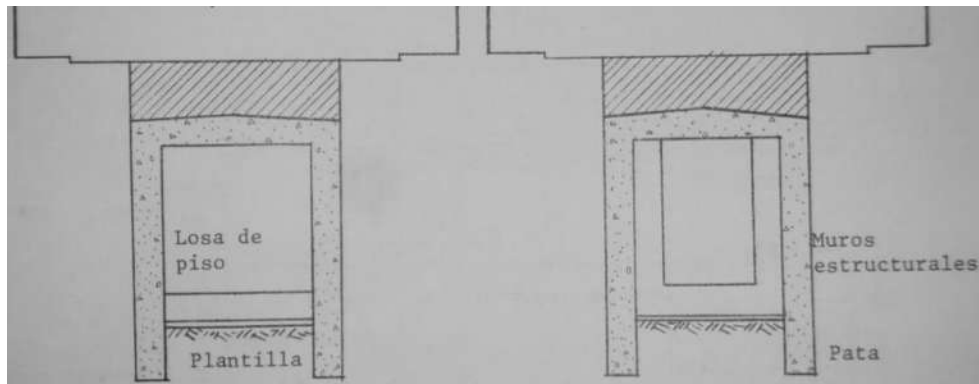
Colado de losa de piso y muros estructurales interiores
